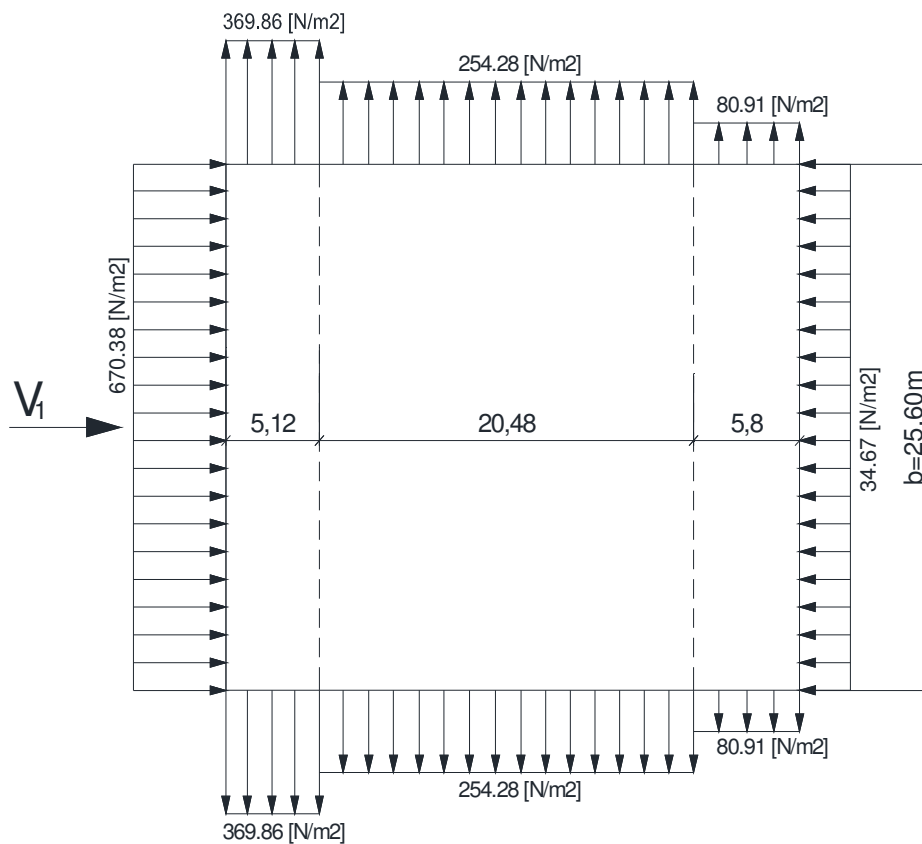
Pression du Vent – Parois verticales -Pignon façade Nord
